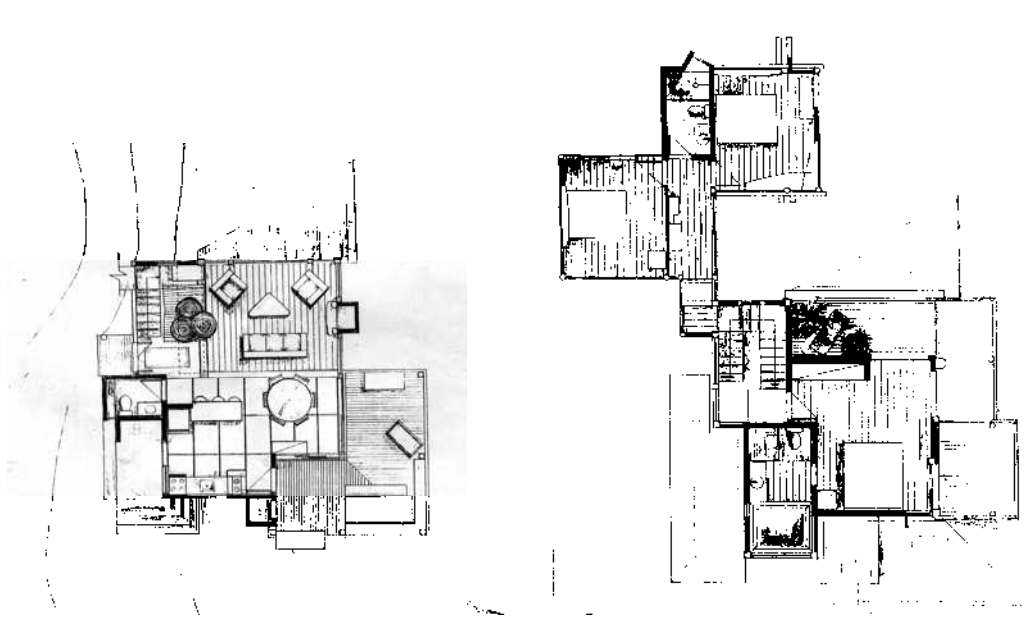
Planta baixa pavto térreo (esq.) e pavto superior da casa na Barra da Ibiraquera (sem escala).
